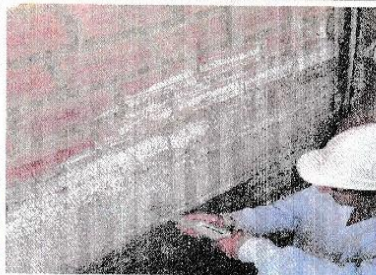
VIGA UBICADO EN EL 1ER. PISO EJE B-C/2-2, SE UBICA A LA ENCIMA DE LA VENTANA ÚLTIMO DORMITORIO
